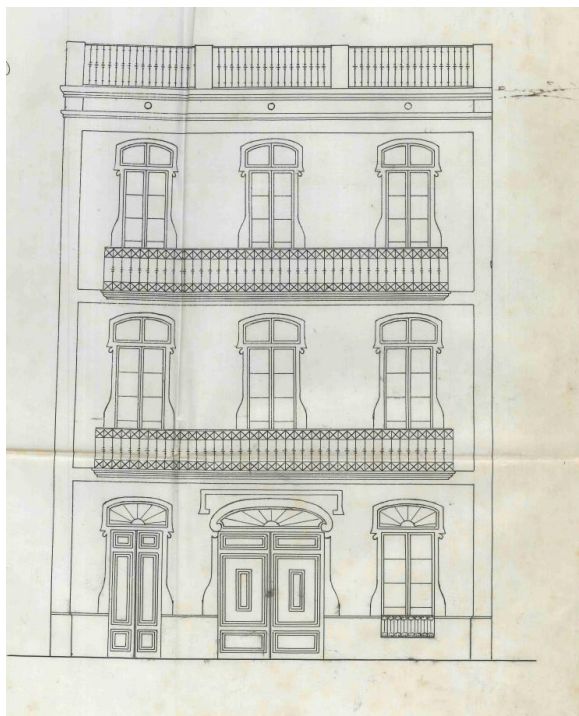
Planos originales archivo municipal de Vilagarcía de Arousa.
